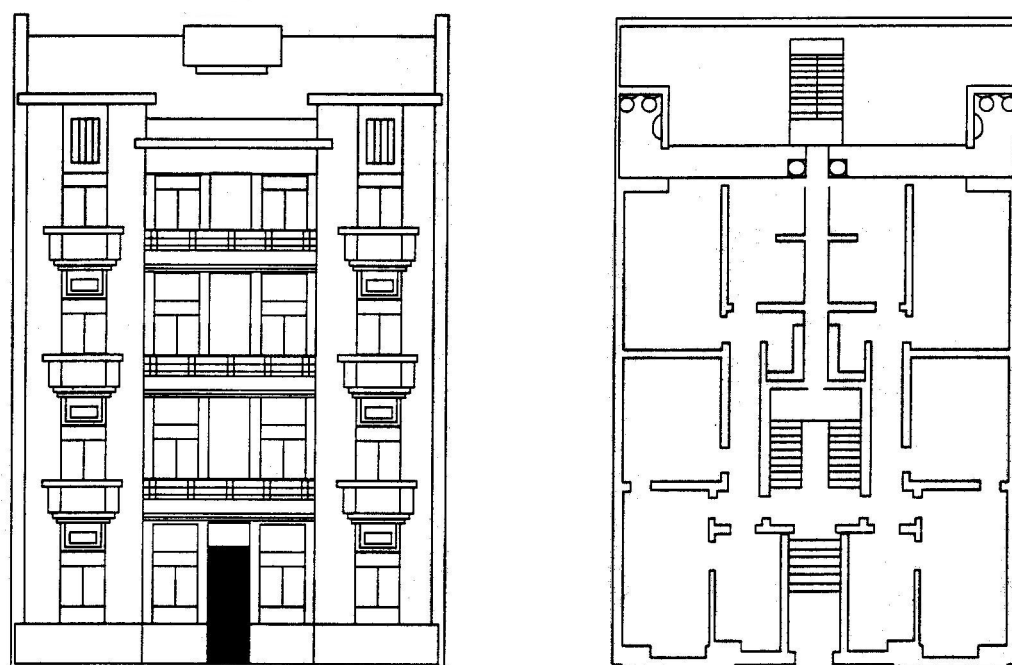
Residencial Avenidas Novas, Lisboa, Portugal: elevação e planta de baixa hierarquia (Fonte: CALLADO, 1989)
